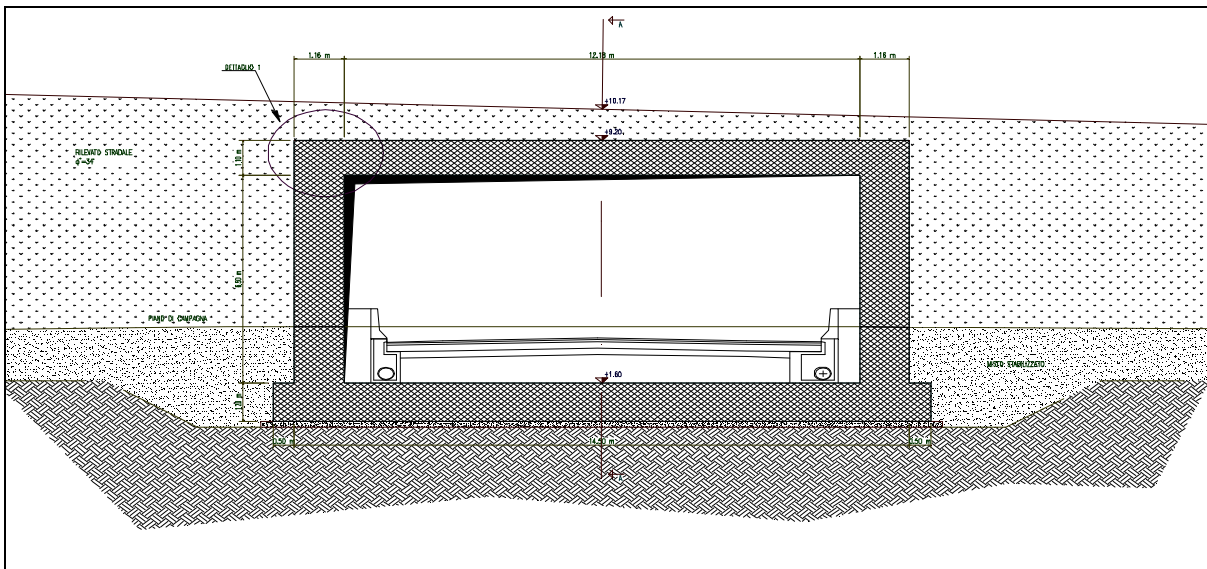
Sezione trasversale B-B del sottovia S.S. n. 16
